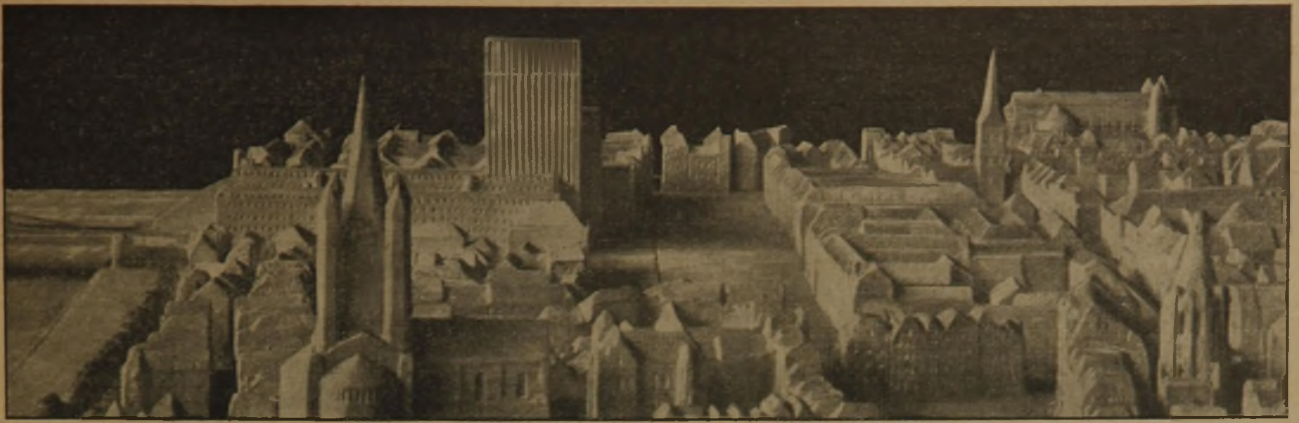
(oben). Schaubild nach Modell. Abb. 34 (rechts). Lageplan.
